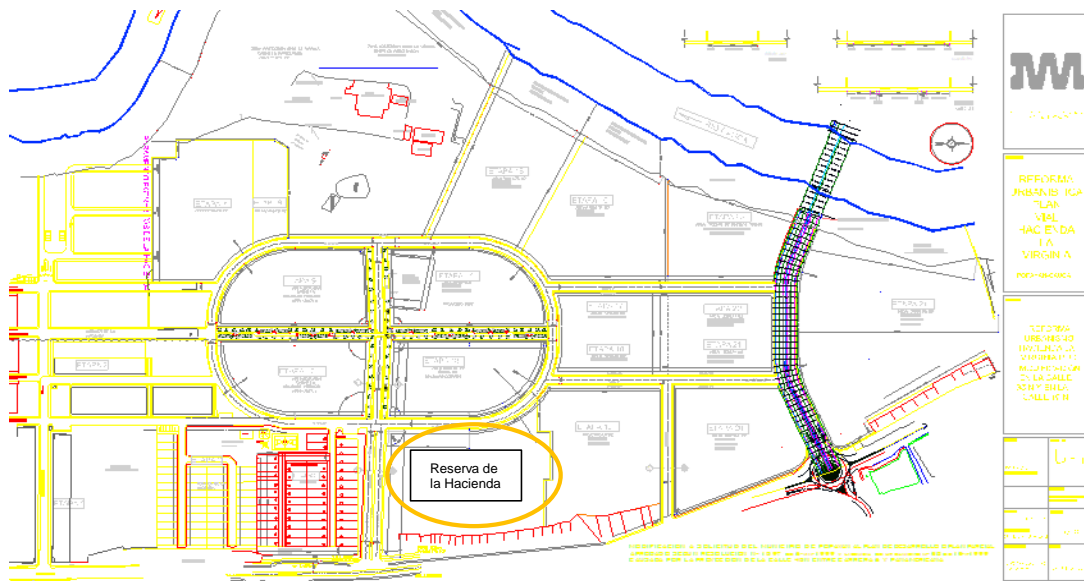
Plano Plan Parcial Hacienda la Virginia. Fuente Anglo Angulo & C.I.A S.C.A
